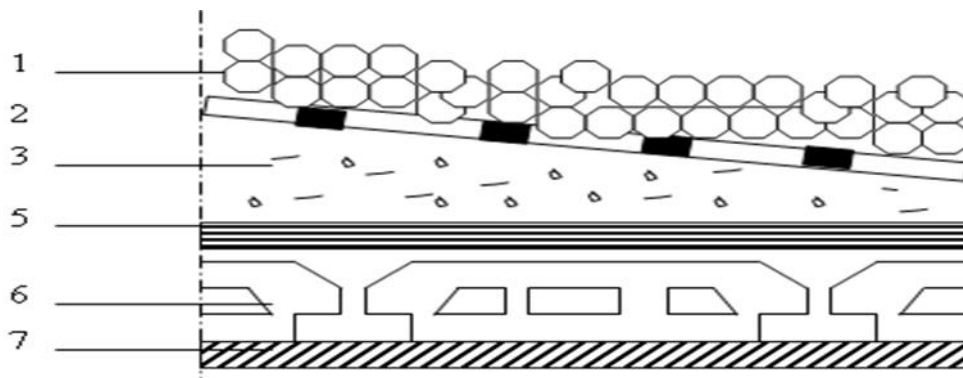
Coupe ver du plancher terrasse inaccessible.
